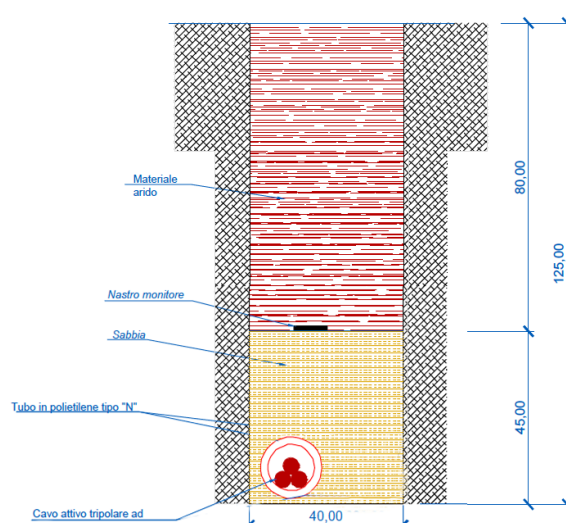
Sezione tipica di posa della linea di cavo su strade sterrate
